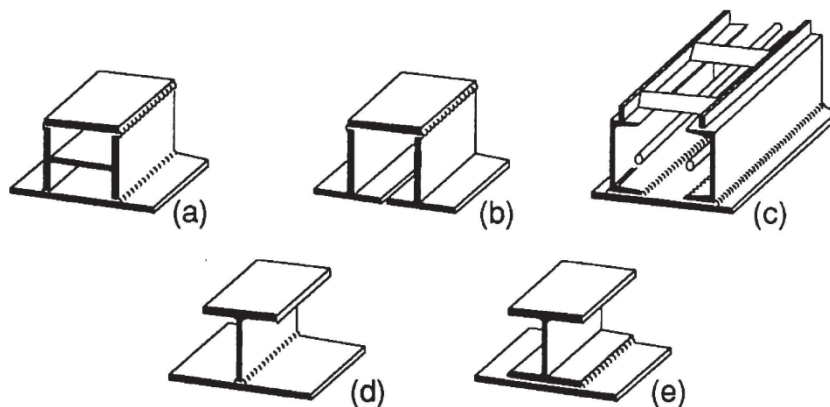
Diversos tipos de secciones actuales de vigas metálicas embebidas en el forjado [11]
